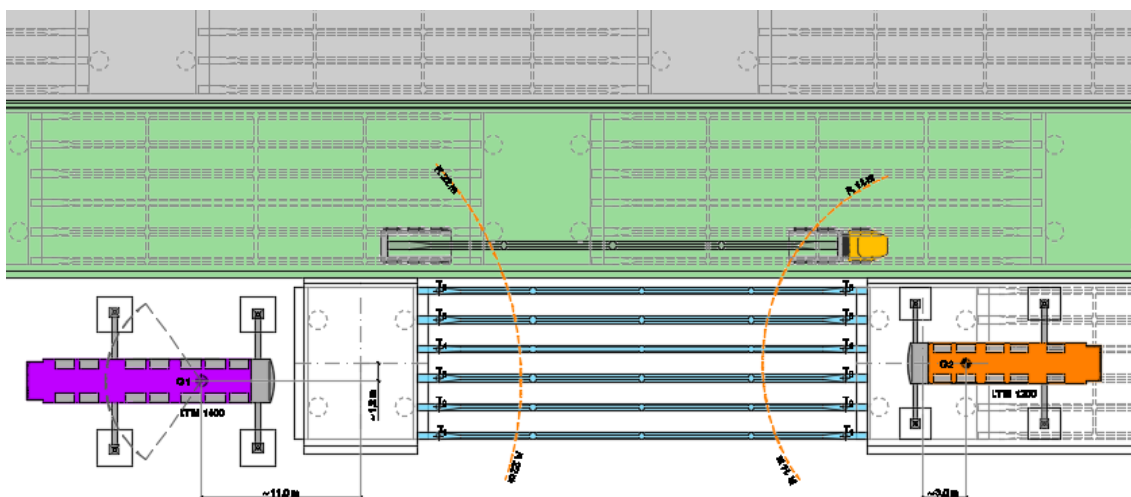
Piazzamento mezzi di sollevamento campata tipologica
